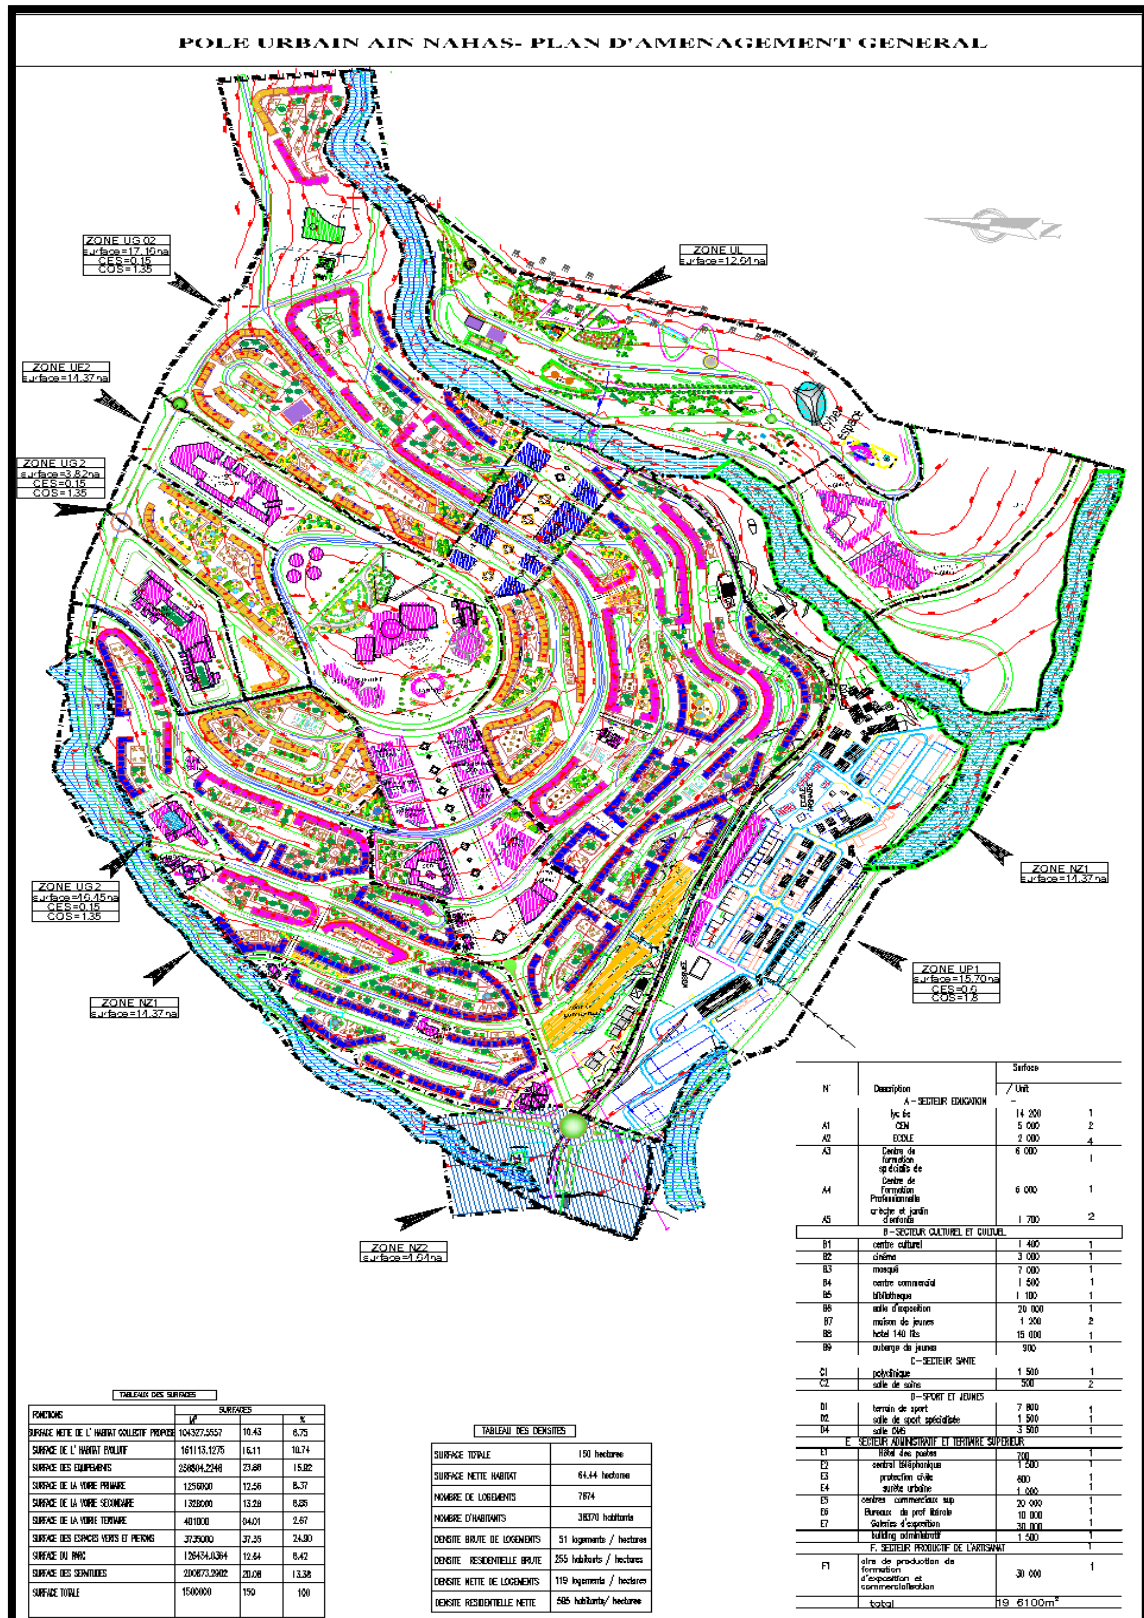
Plan d'aménagement général d'Ain Nahass
